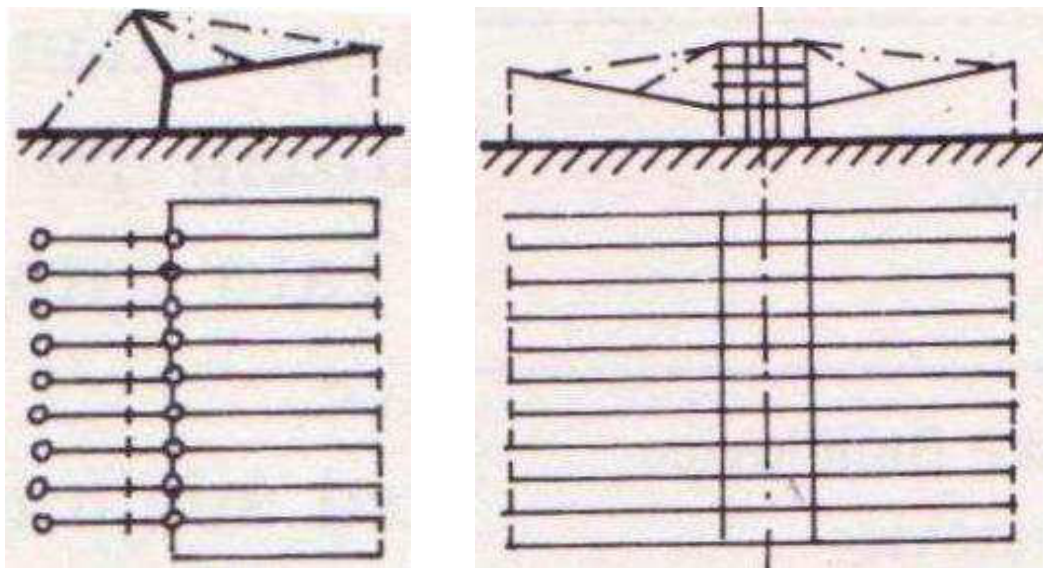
Zavěšená konstrukce zastřešení hangáru v Praze [7]
